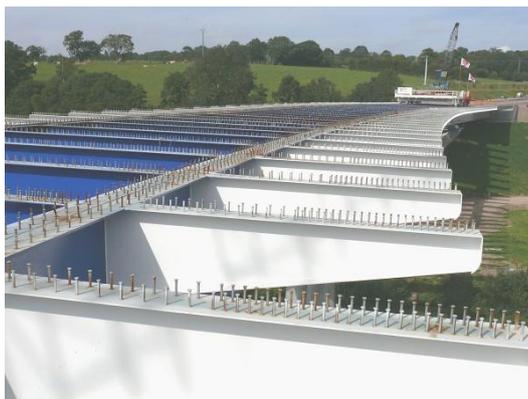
Goujons permettant la liaison du hourdis en béton armé à la charpente, Viaduc de la Souilles (Manche) image J. Mossot Structurae [4]
